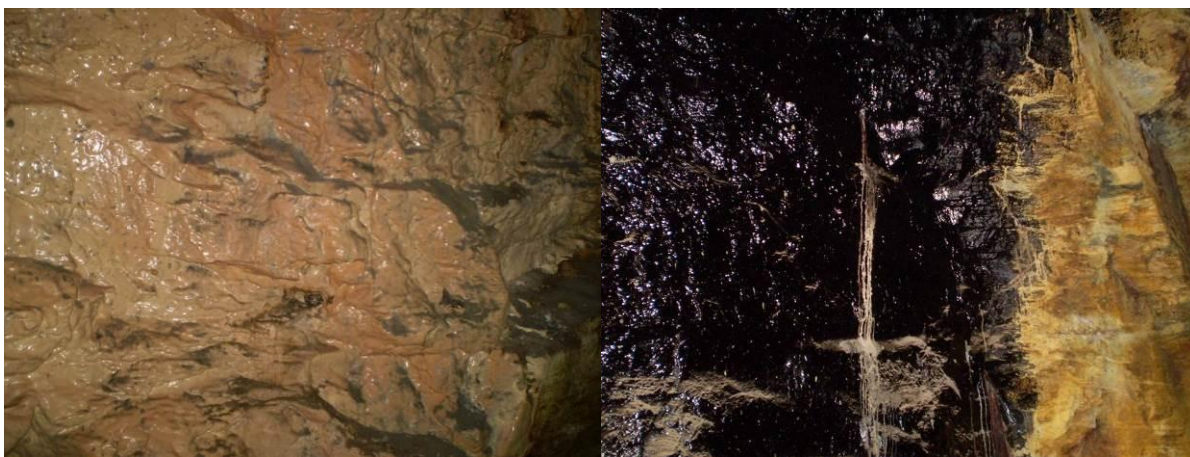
Aplicação de proteções impermeabilizantes em galeria de drenagem, para teste.
